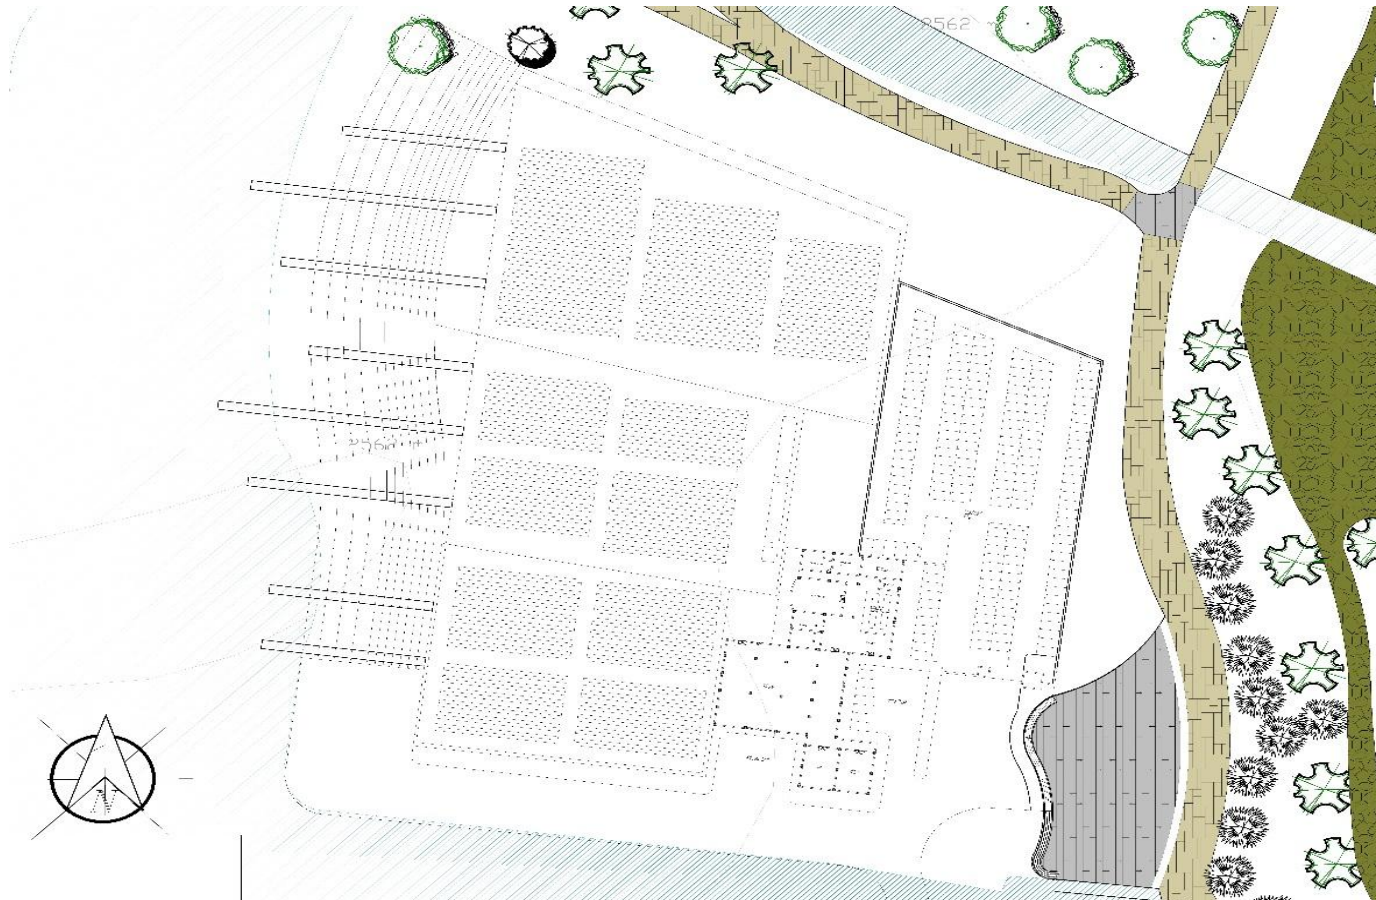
Planta floricultivos . Fuente : Elaboración propia
